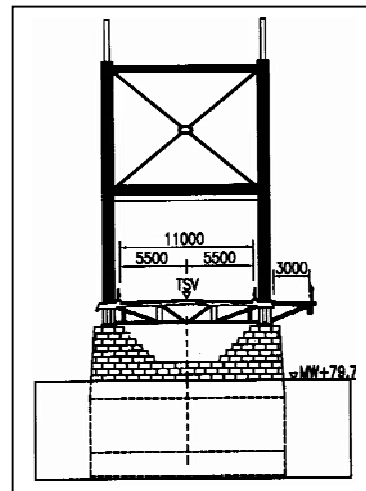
Brückentafel Mischkonstruktion aus Holz, Stahl und Beton
